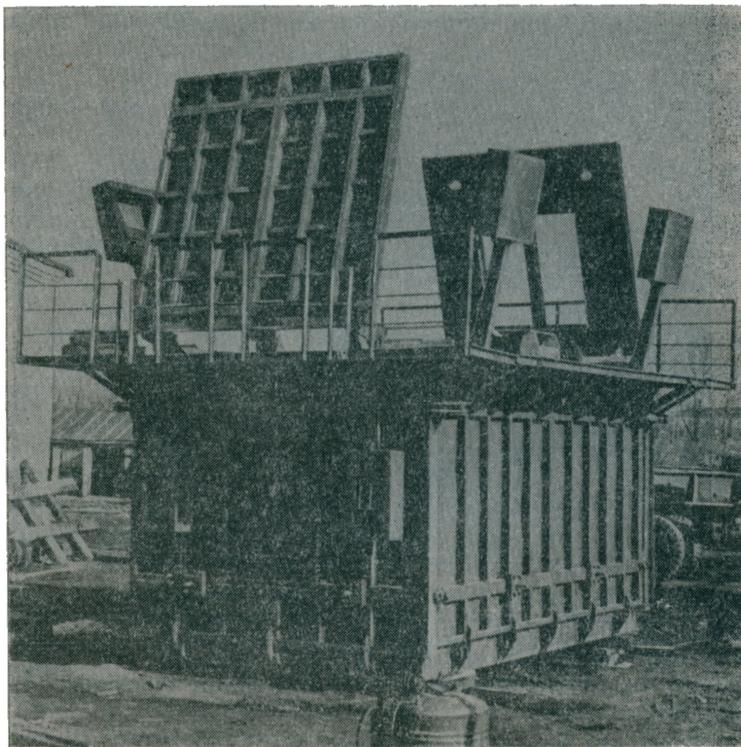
Общий вид установки для изготовления блоков-комнат.
